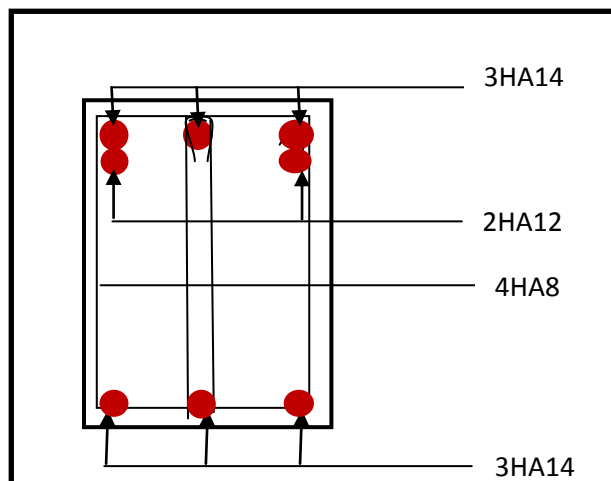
Ferrailage aux appuis d'une poutre secondaire.
